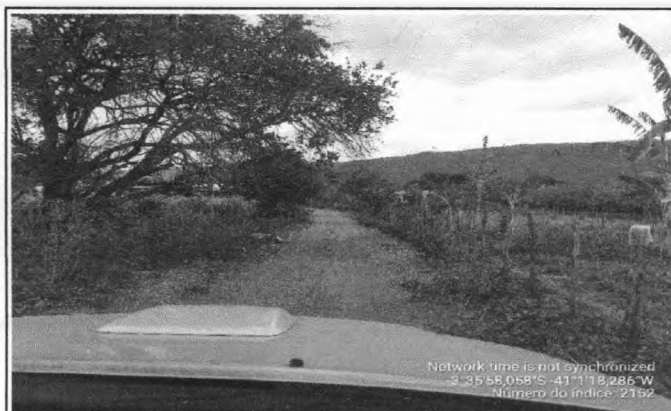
LOCAL DA CONSTRUÇÃO DO BUEIRO
